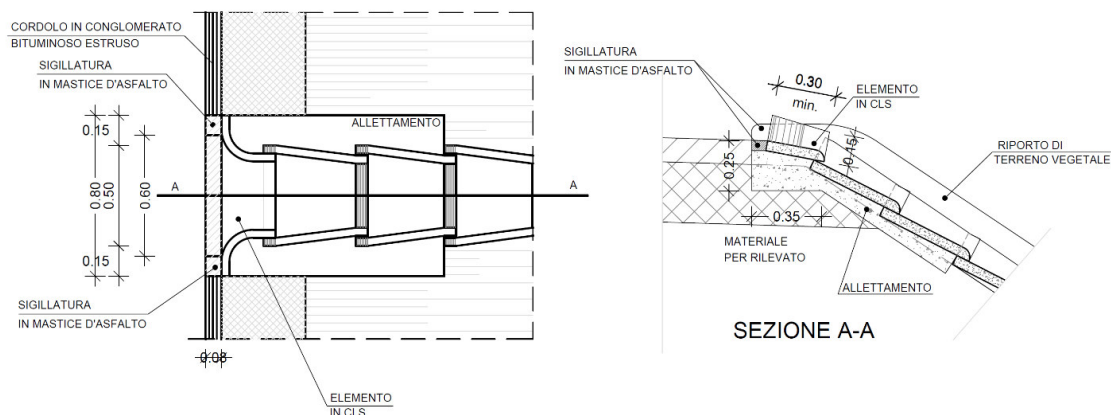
Dettaglio in pianta e sezione testa embrici su piattaforma ferroviaria
